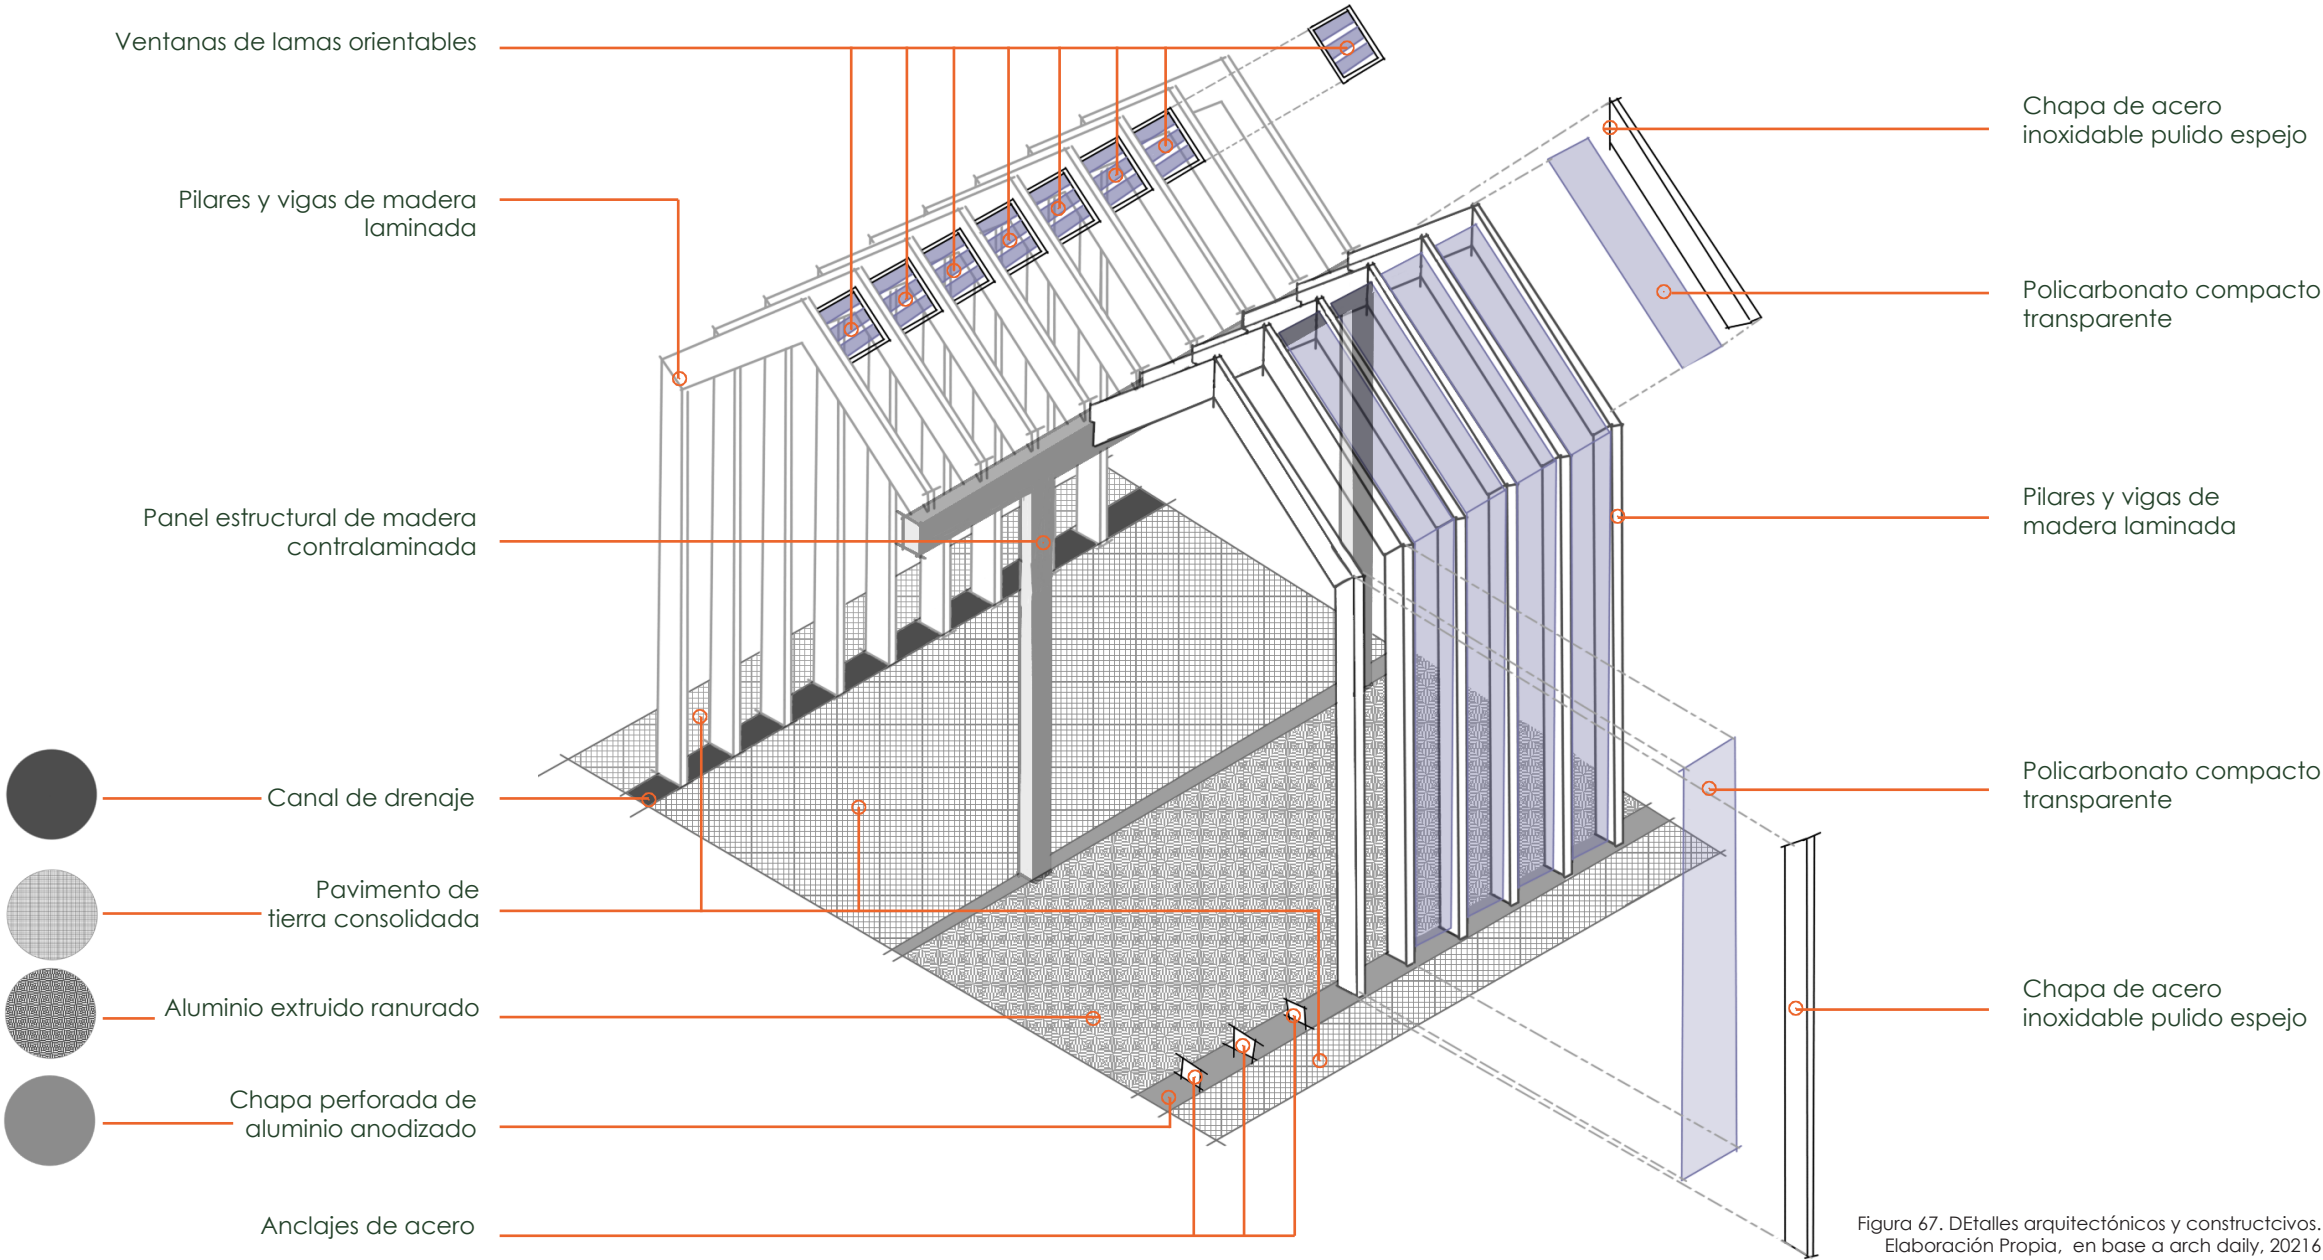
DEtalles arquitectónicos y constructivos. Elaboración Propia, en base a arch daily, 20216
